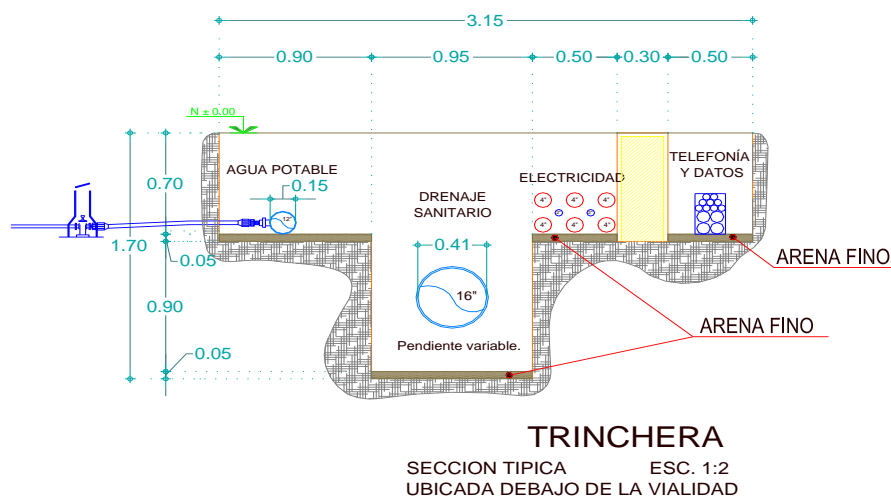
Sección de trinchera para alojar la infraestructura subterránea proyectada. Fuente: A. UG Arquitectos.
